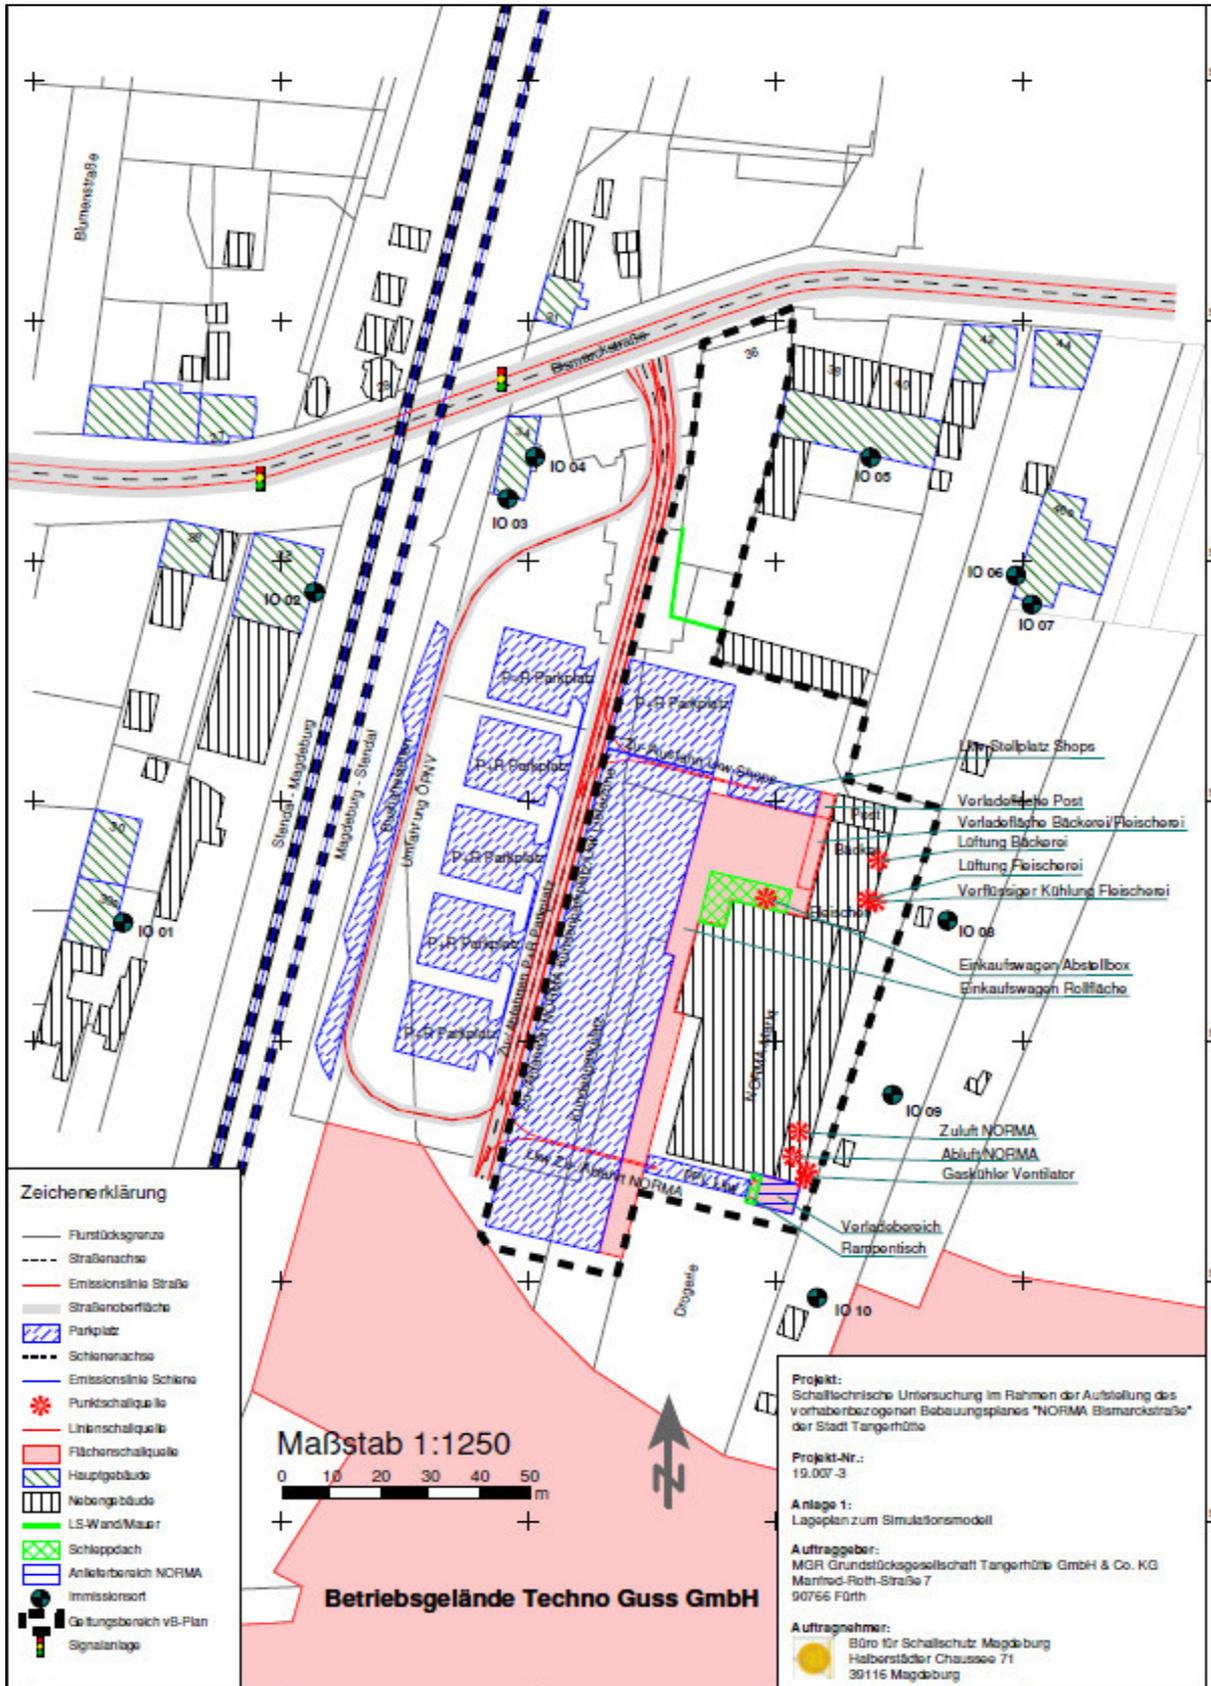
Lageplan Simulationsmodell (Quelle: Schallschnische Untersuchung Stand: 06.11.2020)
